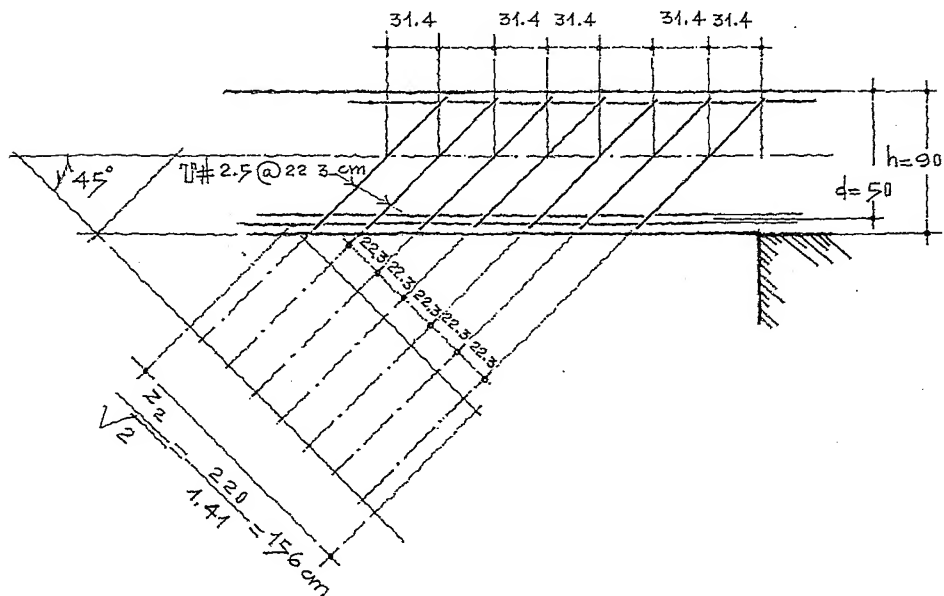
Diagrama para obtener la separación de estribos a 45° .
